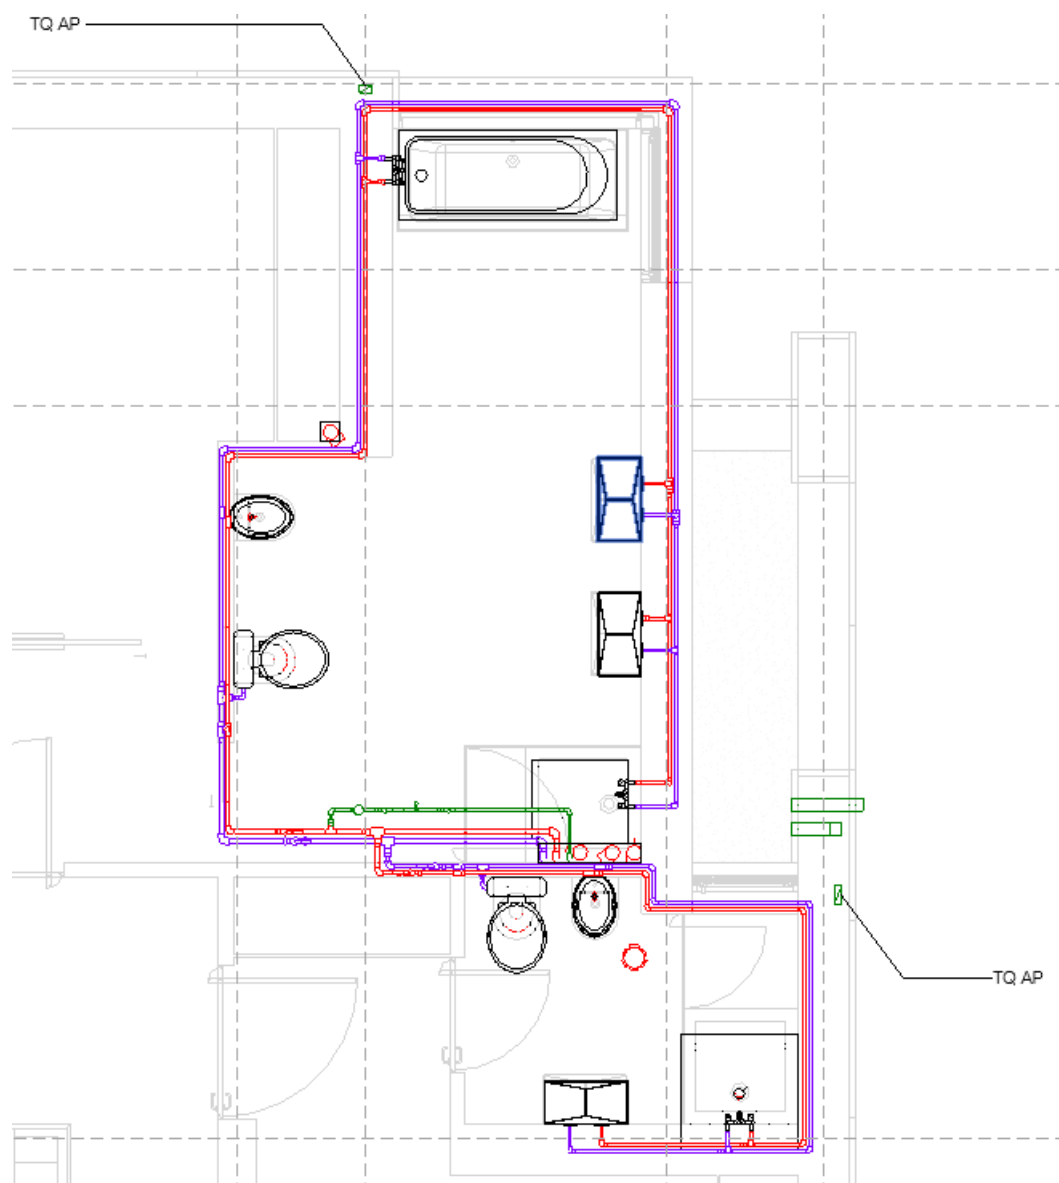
Divisão (1) em planta do piso 2 da rede predial de abastecimento
